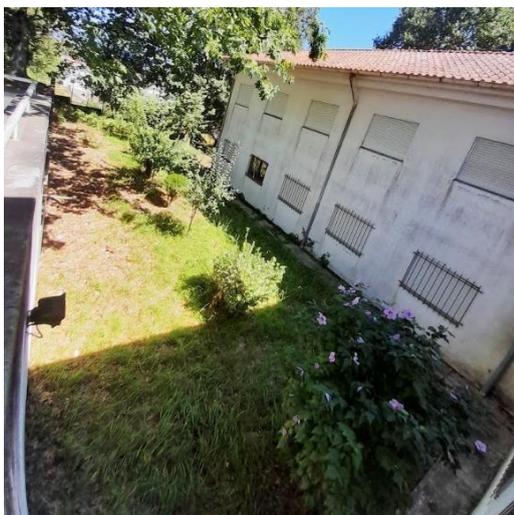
Área permeável na zona Oeste da área de intervenção. | Fonte: Autora, 2022
